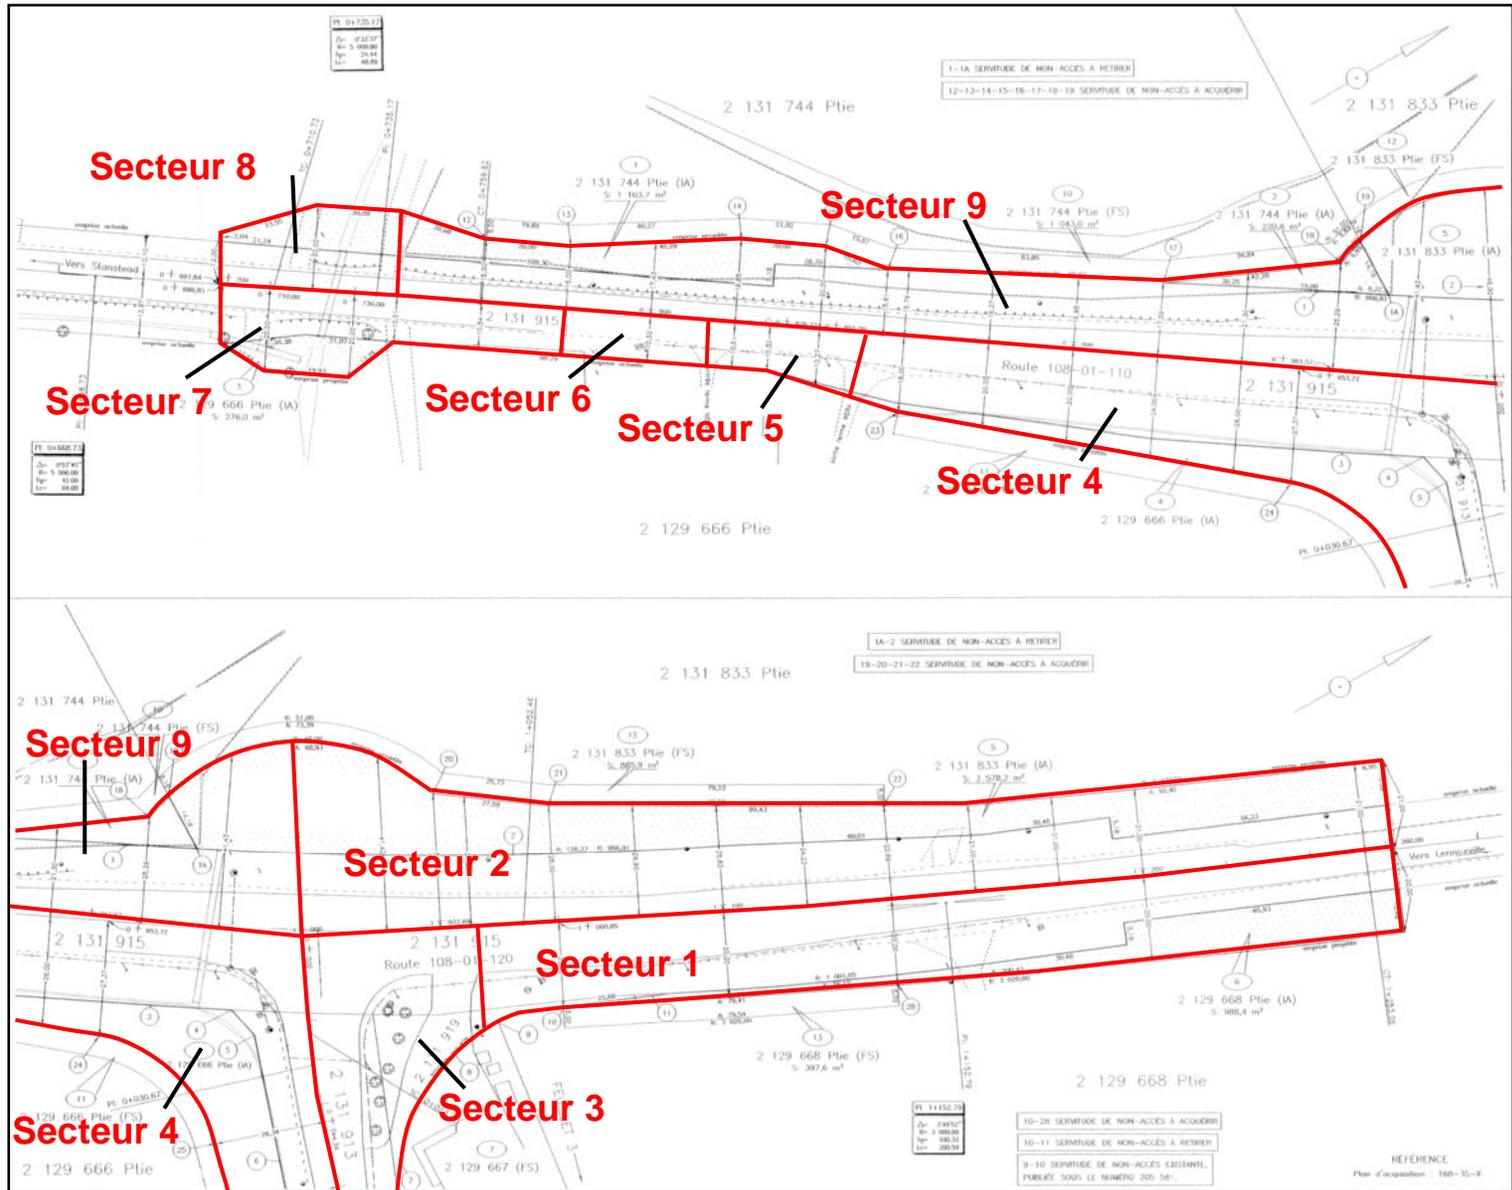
Localisation des secteurs inventoriés, projet n° 154-02-1762 (source : Ministère des Transports, plan d'ensemble [extrait], Plan d'ensemble, plan CH-9007-154-07-1785, 15 mars 2010)
